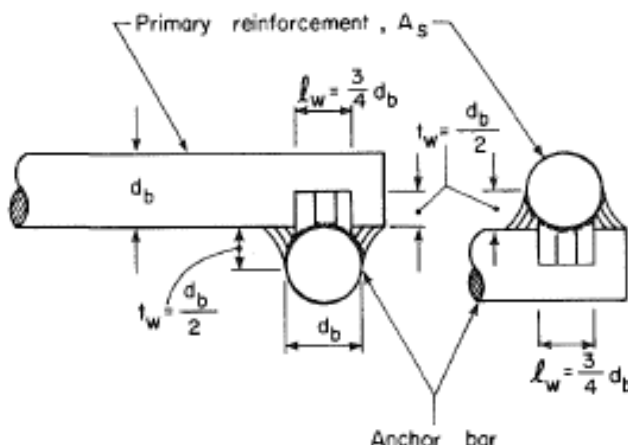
Detalhe de soldadura segundo o ACI [30]
